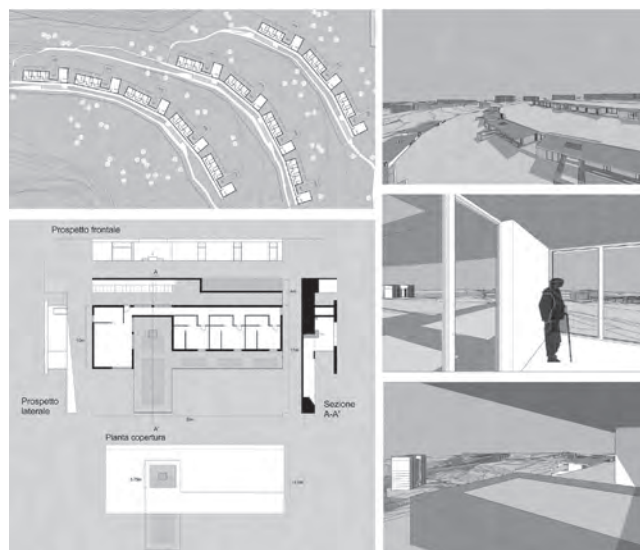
Planimetria, pianta e sezione degli alloggi disposti assecondando le curve di livello
